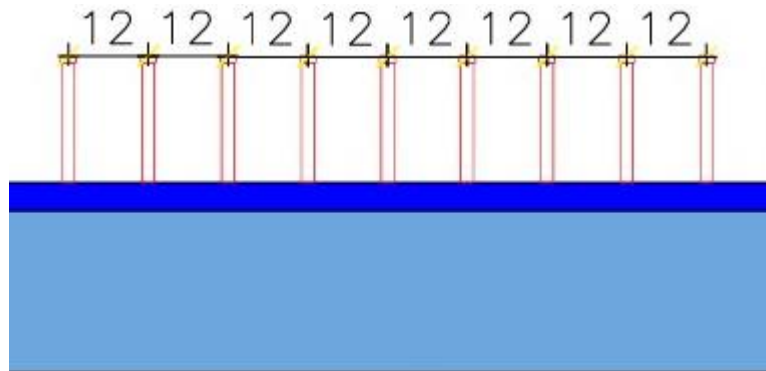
Disposition longitudinale des goujons dans les différentes sections.
